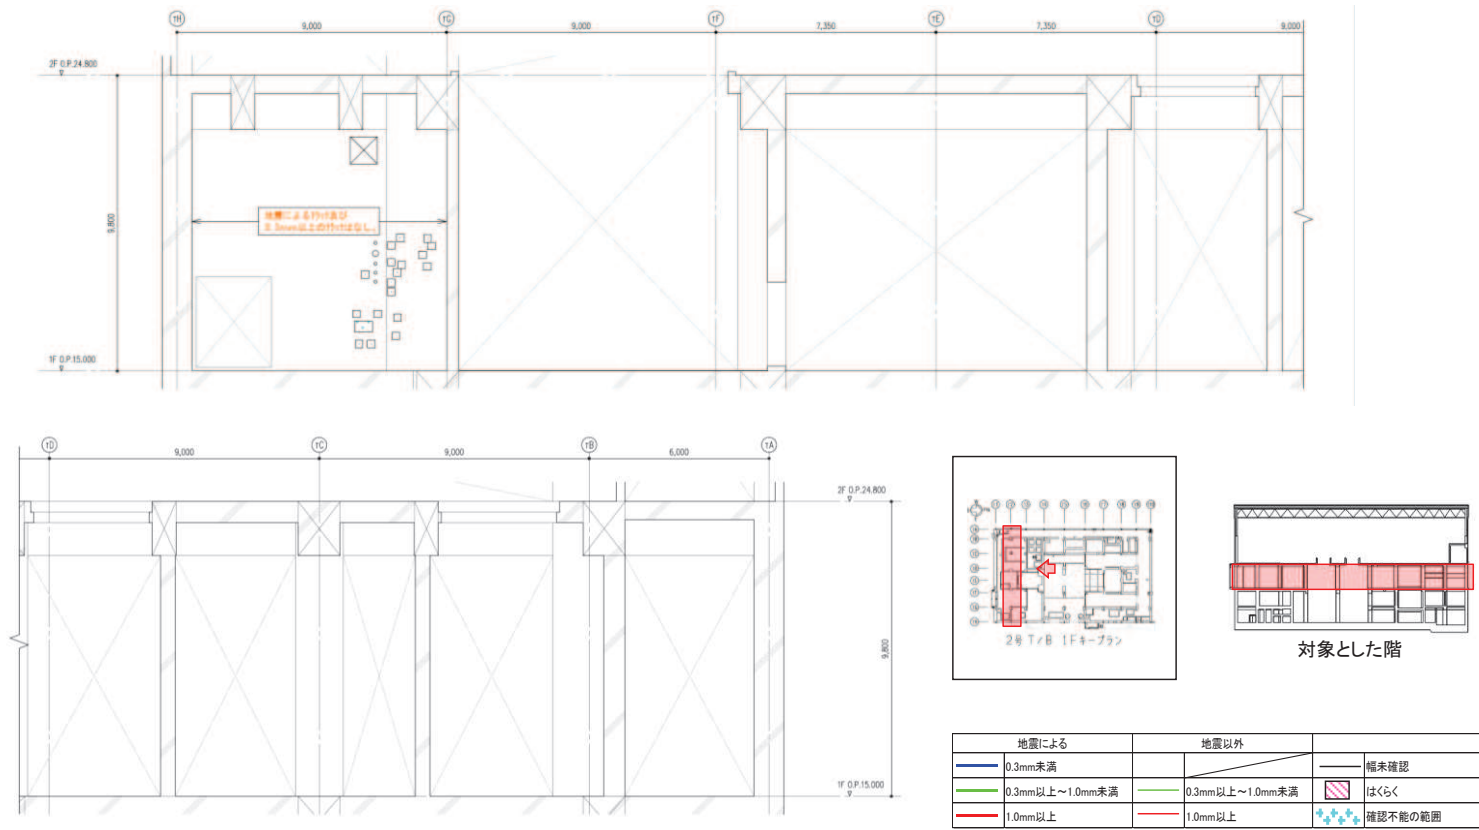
タービン建屋のひび割れ分布 耐震壁 (34) 1階 T2 通り
